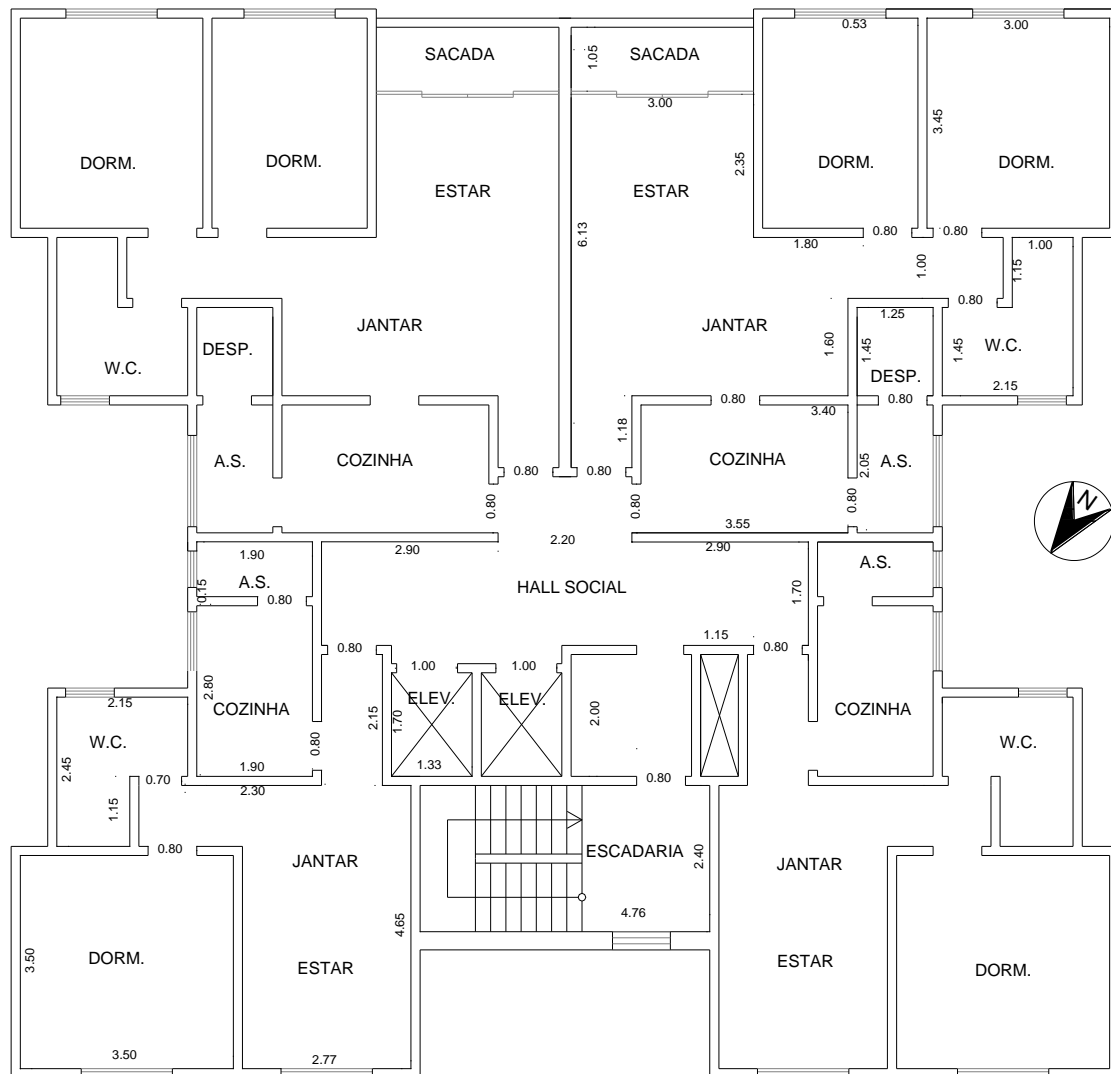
Planta do pavimento-tipo – Residencial Navarro.
